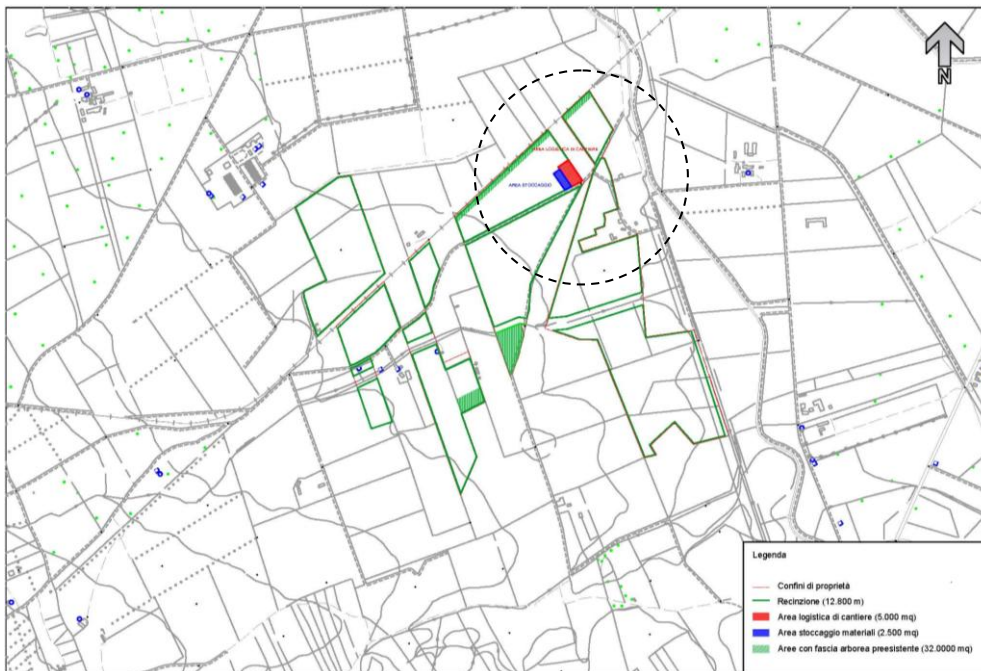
Collocazione area logistica di cantiere e area di stoccaggio nel sito di intervento.
